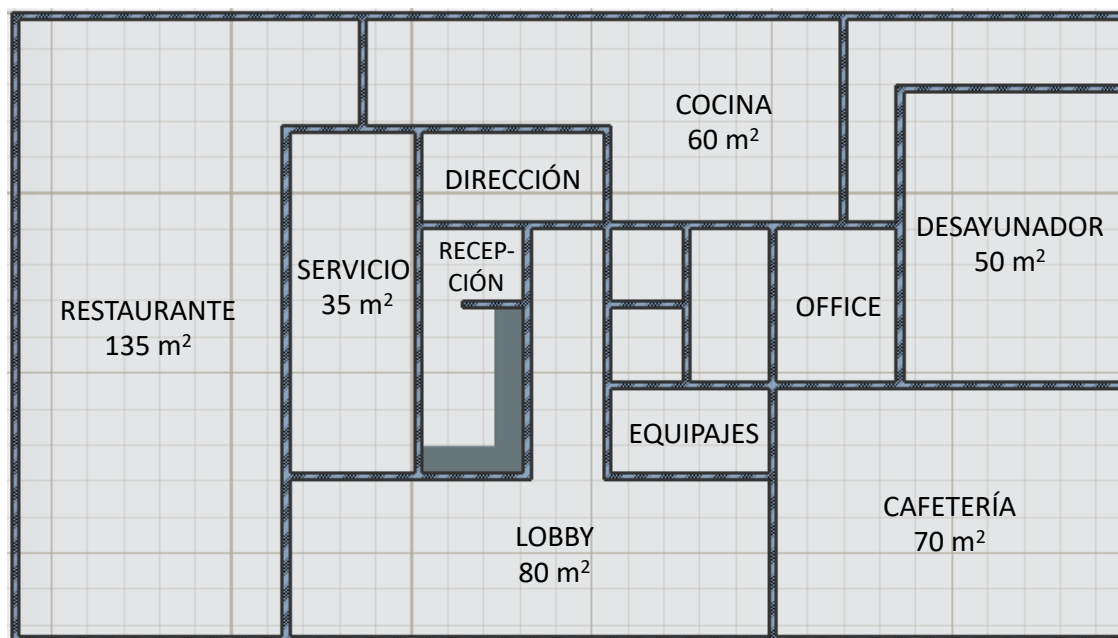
Planos: Planta principal. Fuente: Elaboración Propia
